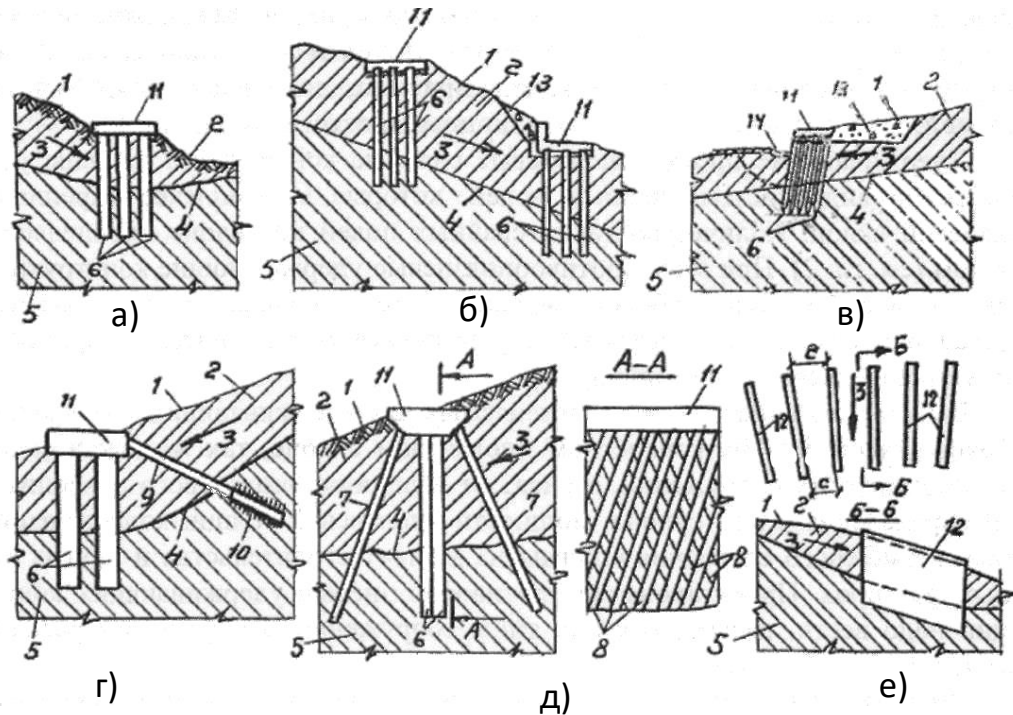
Схеми протизсувних конструкцій глибокого закладення [61]: а – однарусна; б – двох’ярусна; в – з похилими палями; г – анкерна; д – козлового типу; е – з поздовжніх підпорних стін; 1 - поверхня схилу; 2 - зсувна товща; 3 - напрямок руху зсуву; 4 - поверхня ковзання; 5 - стійкі (які не зміщуються) породи; 6 - утримуючі елементи із забивних та буронабивних паль; 7 - зовнішні похилі ряди паль; 8 - внутрішні вертикальні ряди перехресних (похилих поперек руху зсуву) паль; 9 - ґрунтовий анкер; 10 - анкерна частина анкера (розширена п'ята або цементация оточуючих ґрунтів); 11 - залізобетонна плита ростверку (в окремих випадках з підпорними стінами); 12 - утримуючі елементи у вигляді поздовжніх підпорних стін; 13 - дренажна засипка; 14 - водовідвідний лоток
